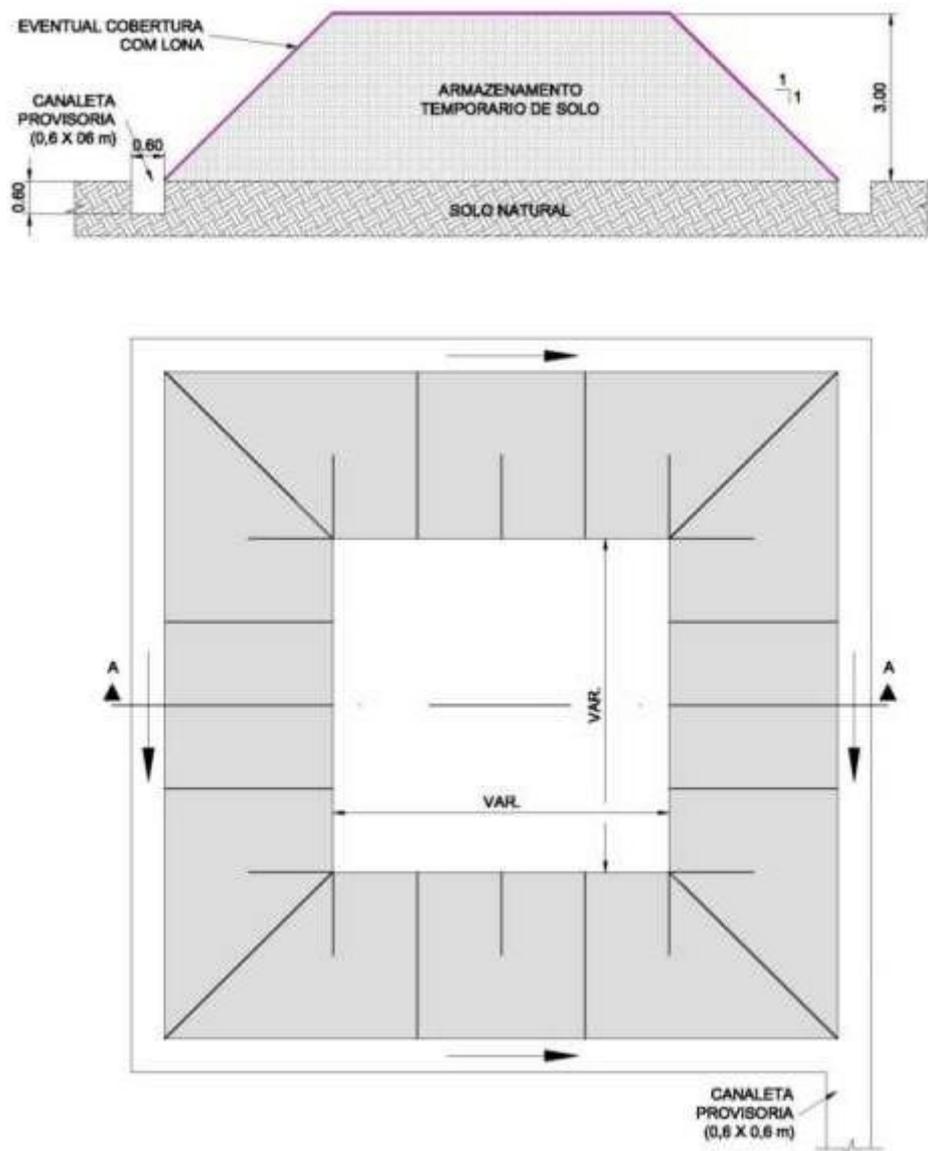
Detalhe esquemático para armazenamento de solo.
